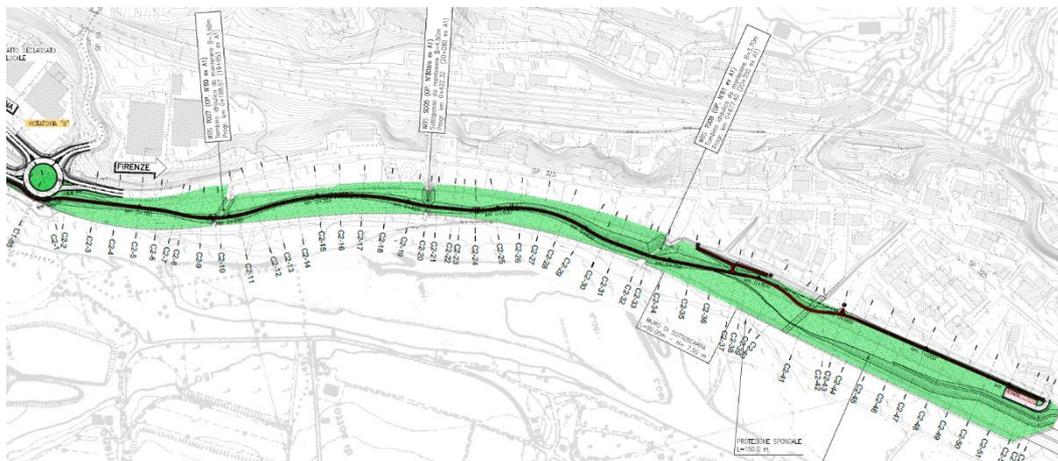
Stralcio planimetrico tracciato pista ciclabile
